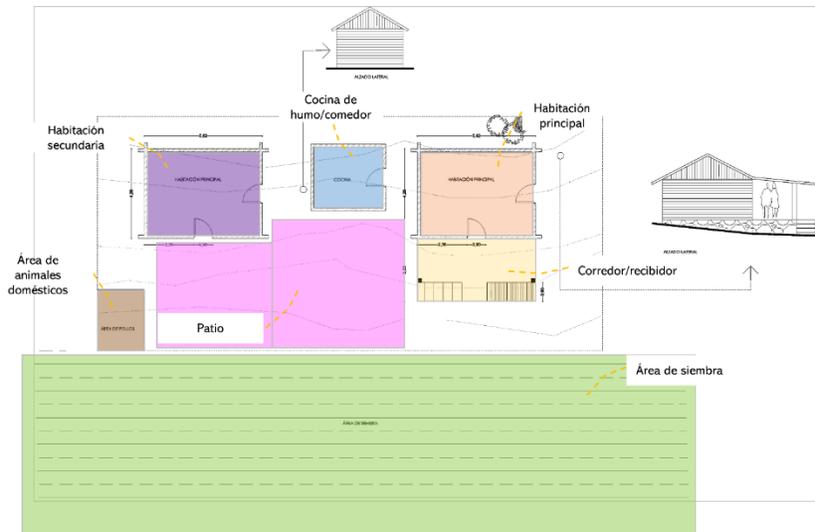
Planta arquitectónica de la vivienda tradicional Mixteca. Fuente: Elaboración propia.
